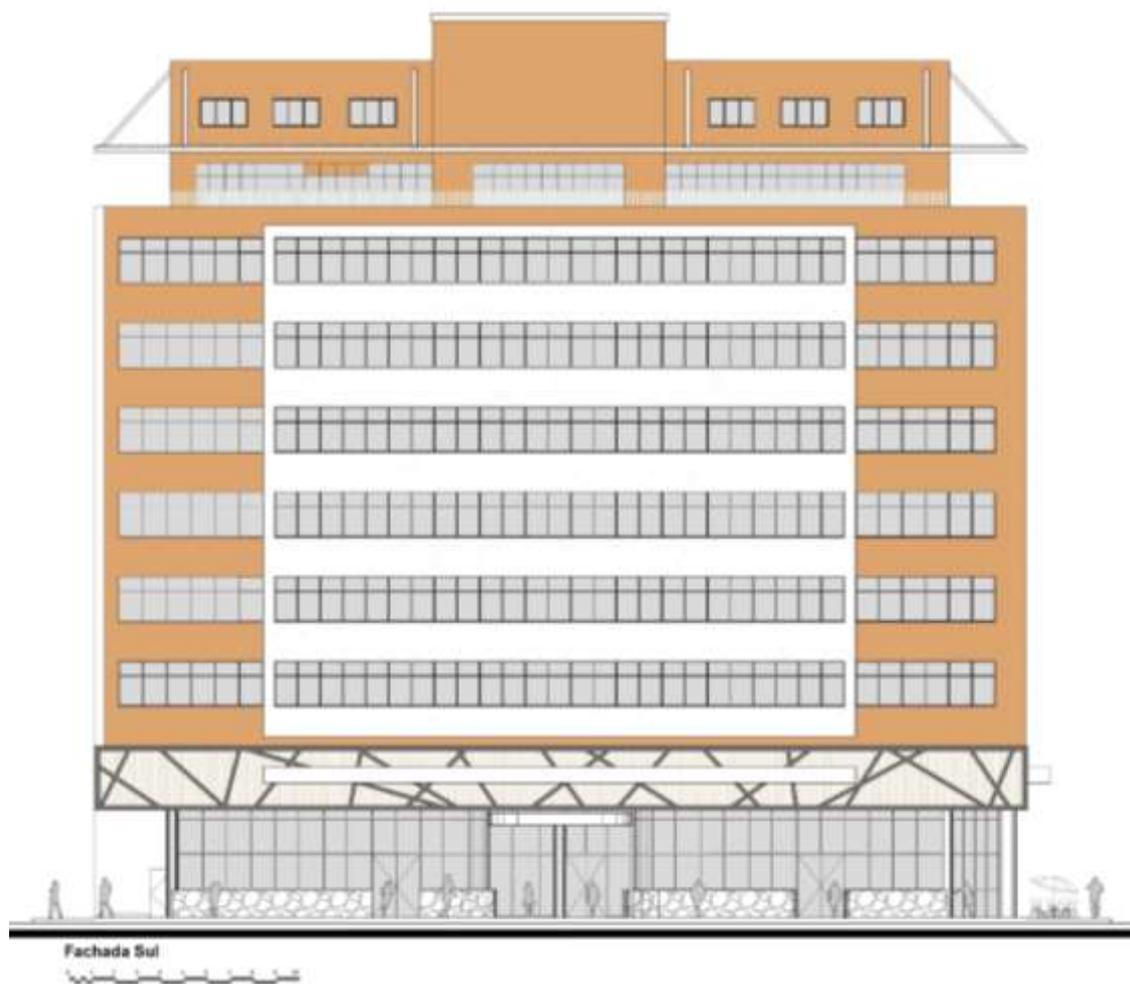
Fachada Sul. Fonte: A autora, 2025.
